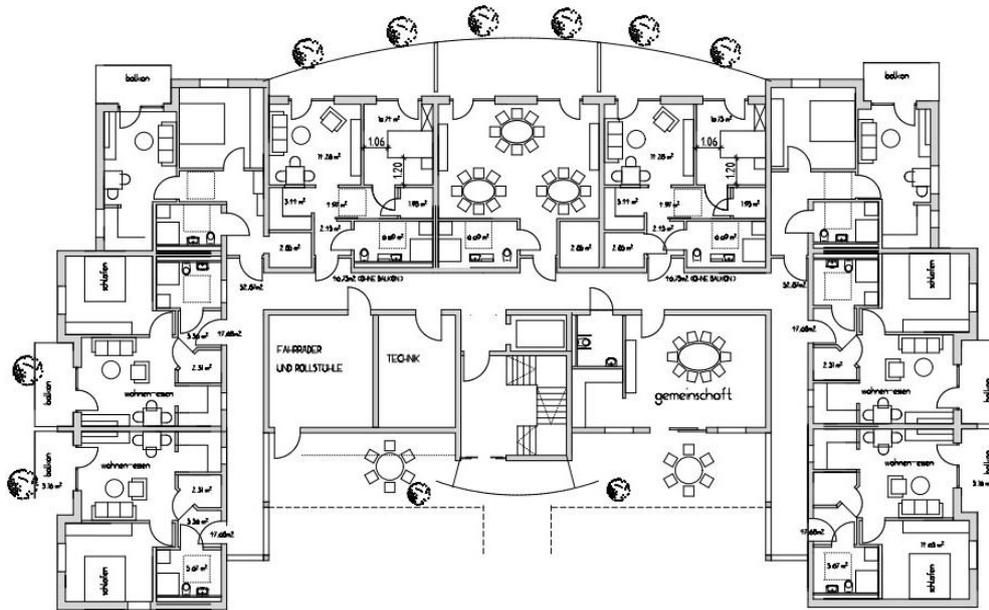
Betreutes Wohnen Grundriss EG
